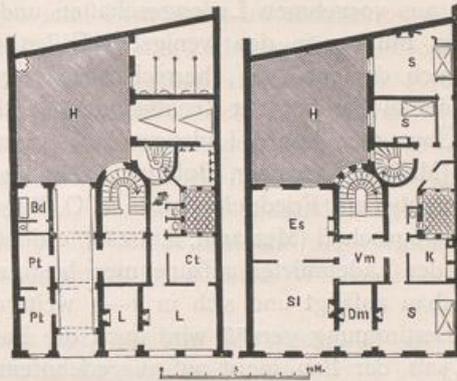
Wohnhaus in Frankfurt a. M. Architekt: P. WALLOT.
